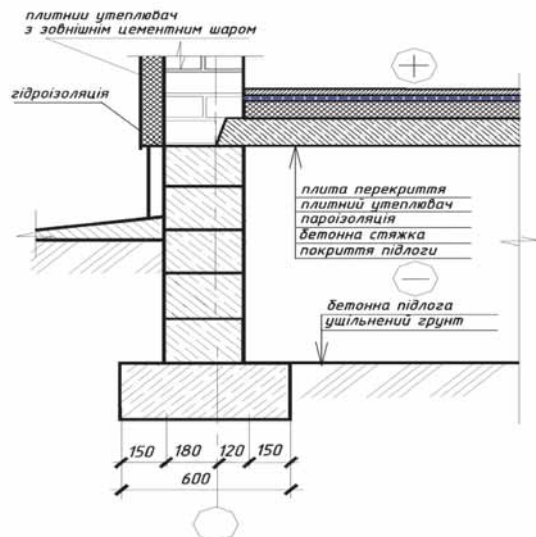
Схема утеплення над неопалюваним підвалом
